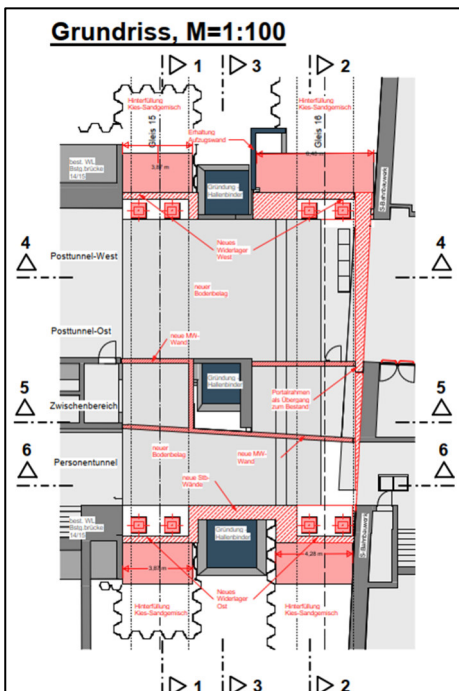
Grundriss des geplanten Neubaus [U2]
